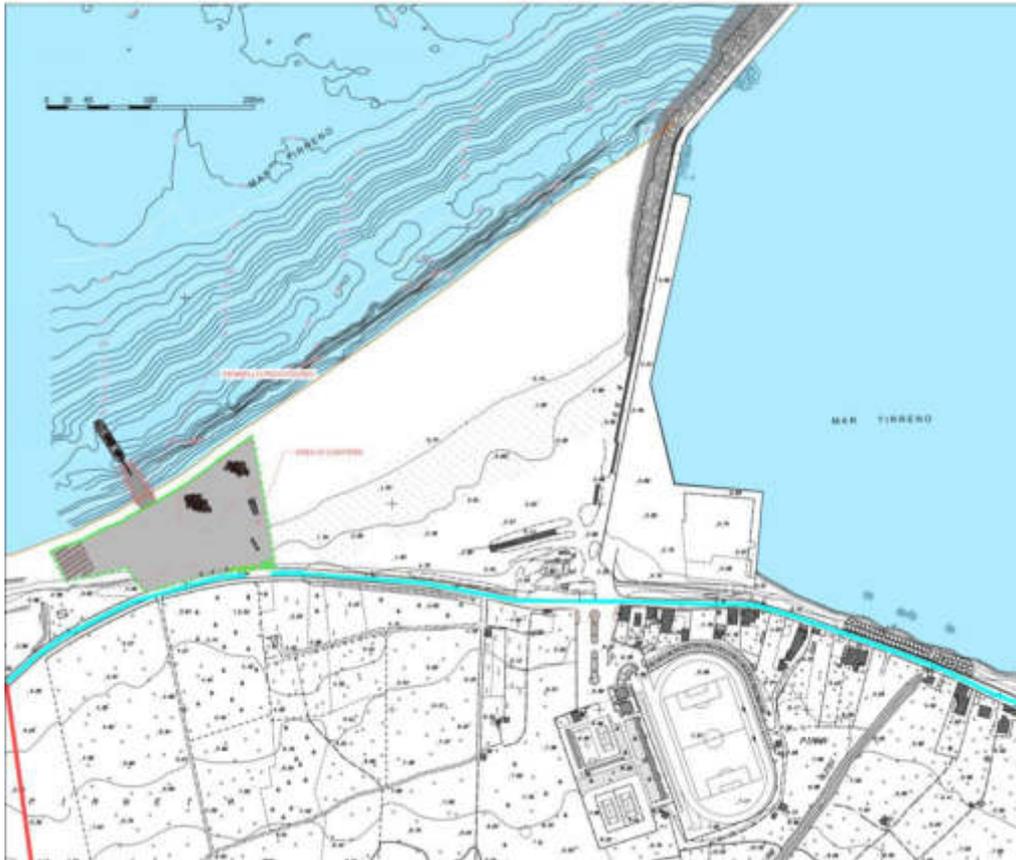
Stralcio planimetria area di cantiere sul progetto esecutivo di completamento
